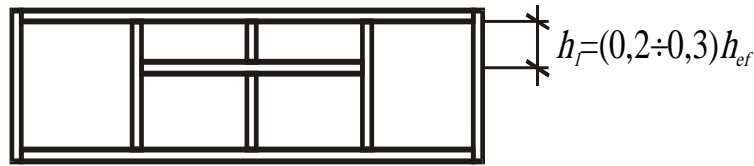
Схема підкріплення стінок балок поперечними та поздовжніми ребрами жорсткості
